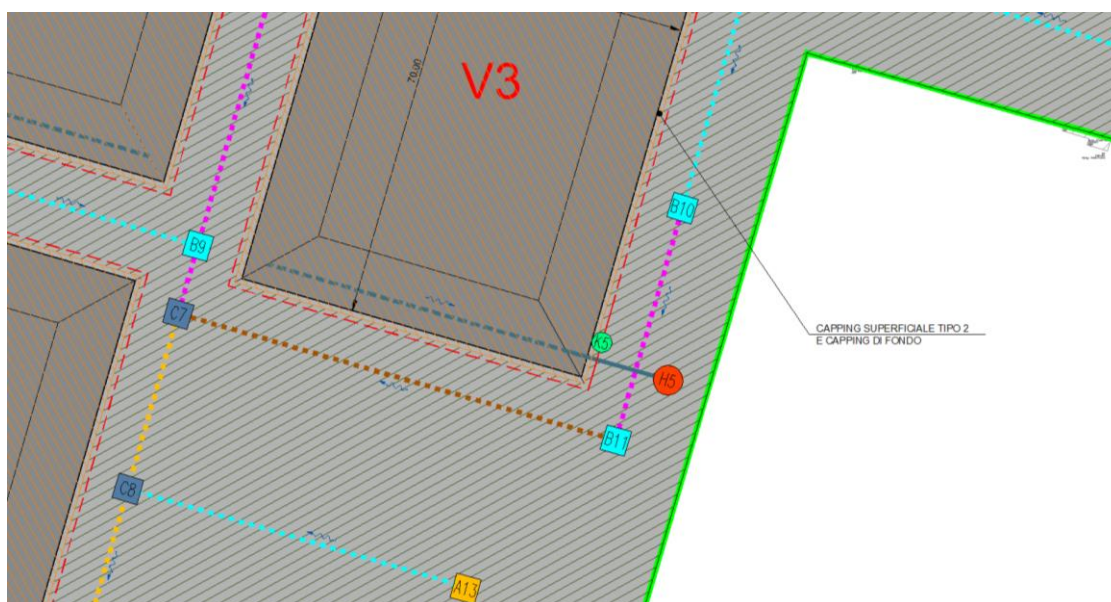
Stralcio planimetrico rete di captazione gas interstiziali nel terreno
